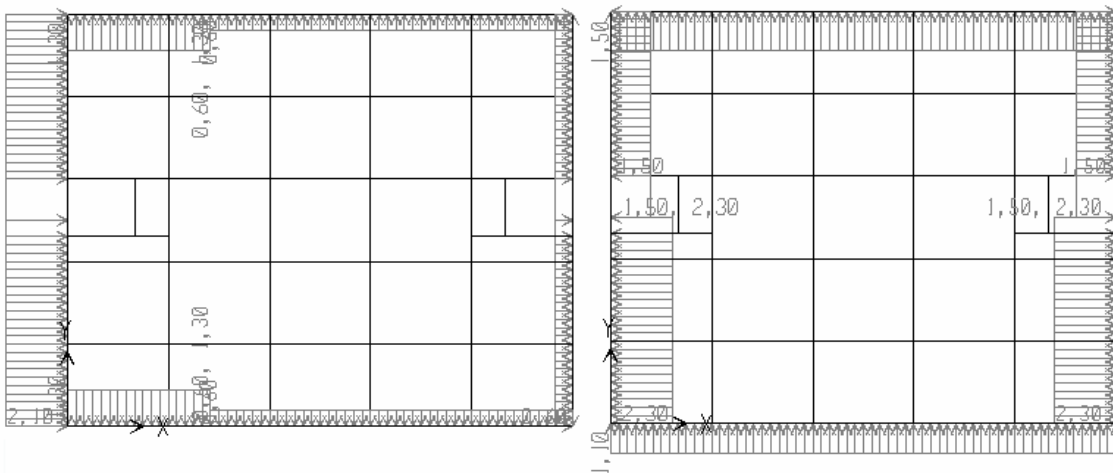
Carregamento de vento no 5º pavimento nas direções x e y.
